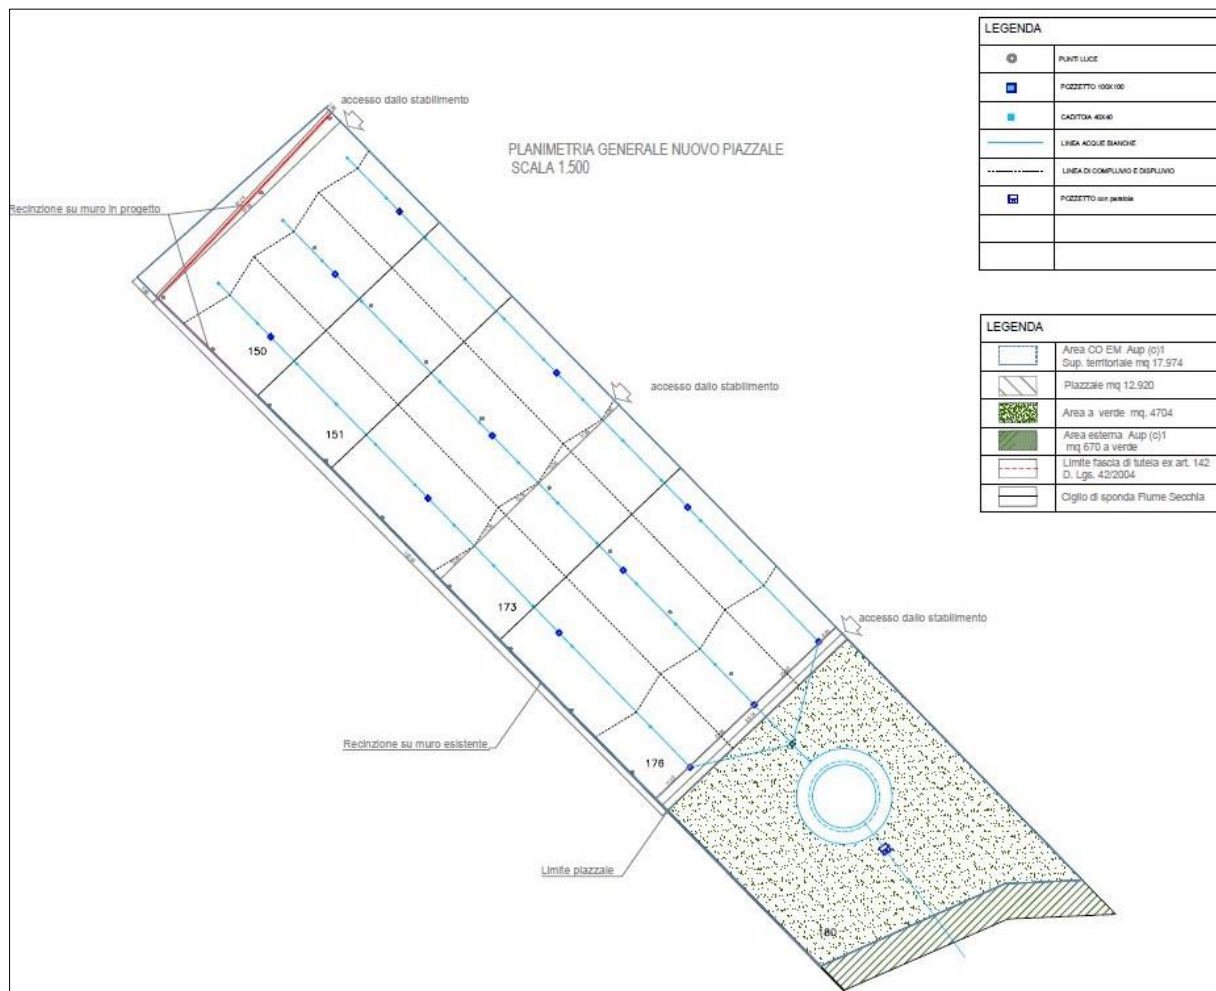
Dettaglio planimetria del nuovo piazzale (parte 2)
